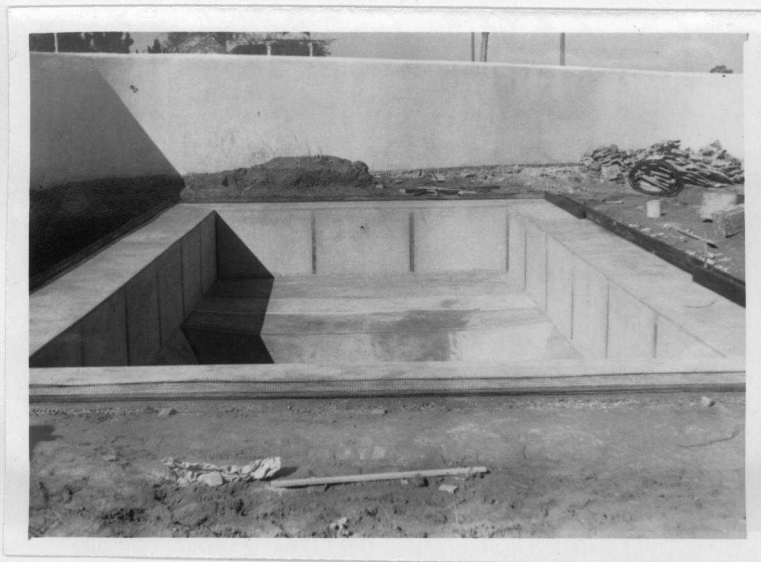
Aspectos finais da construção - Lado raso
